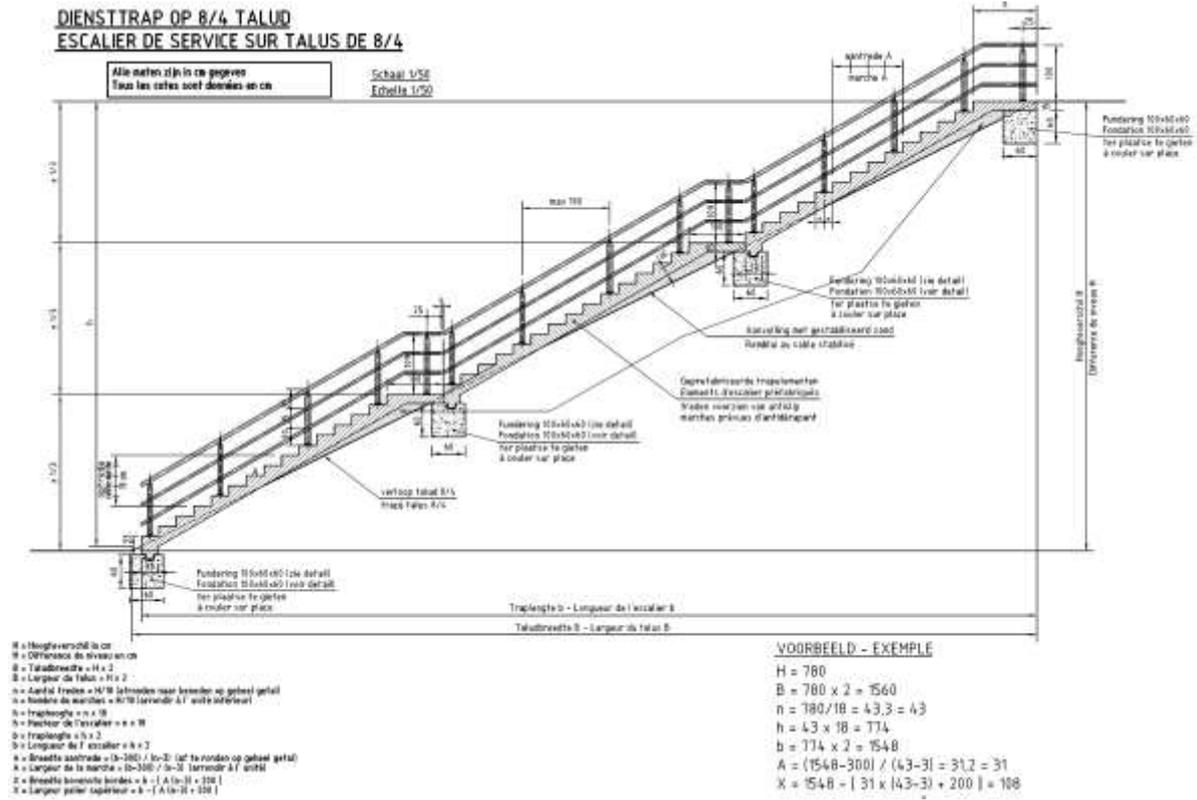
Plan de principe d'un escalier de service sur talus
